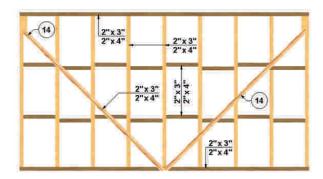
20: Muro arriostrado por medio de diagonales estructurales, de igual escuadría que las piezas principales, pieza N° 14.
